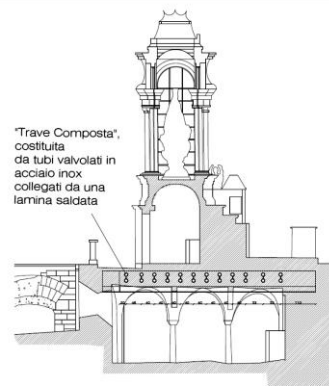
Sezione trasversale: soluzione di consolidamento con "zattera"
